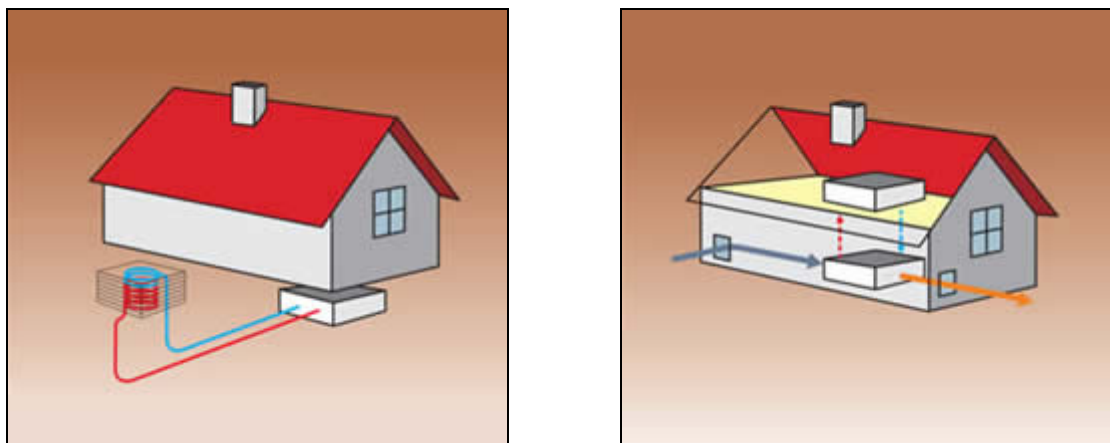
Princip tepelného čerpadla. Zdroj i-EKIS
